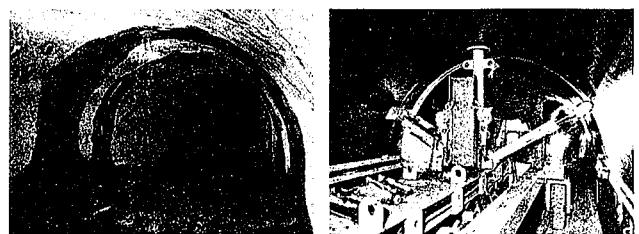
施工前の既設トンネル状況 写真2 鋼板内巻改修工事状況
